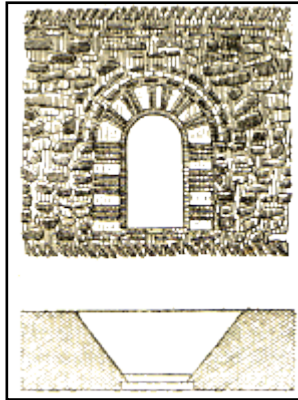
Plan et élévation d'une fenêtre de l'église de Savenières (France). (Source: dictionnaire raisonné d'architecture)
